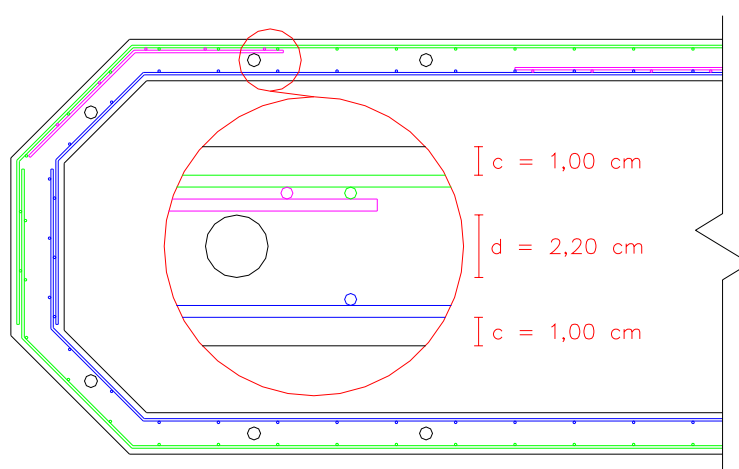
Detalhamento da armadura em tela soldada.
